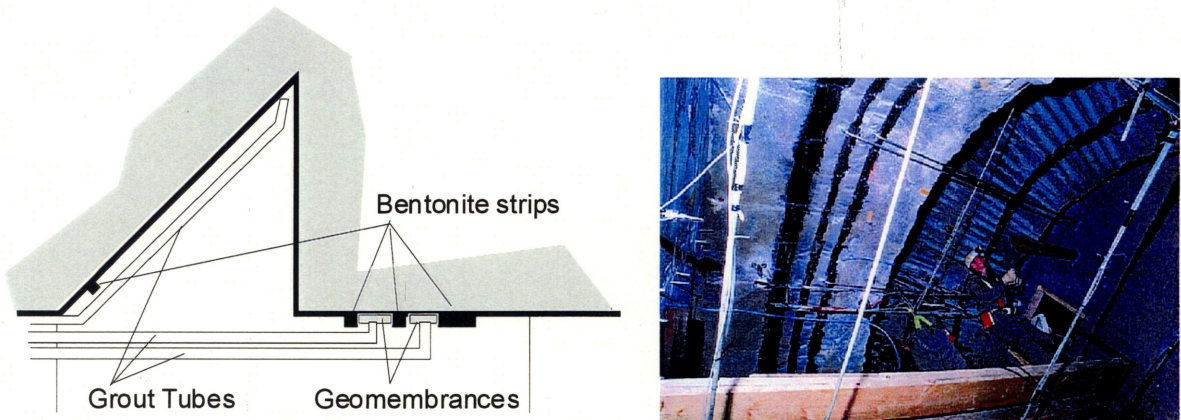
コンクリートプラグ-岩盤間の処置状況
